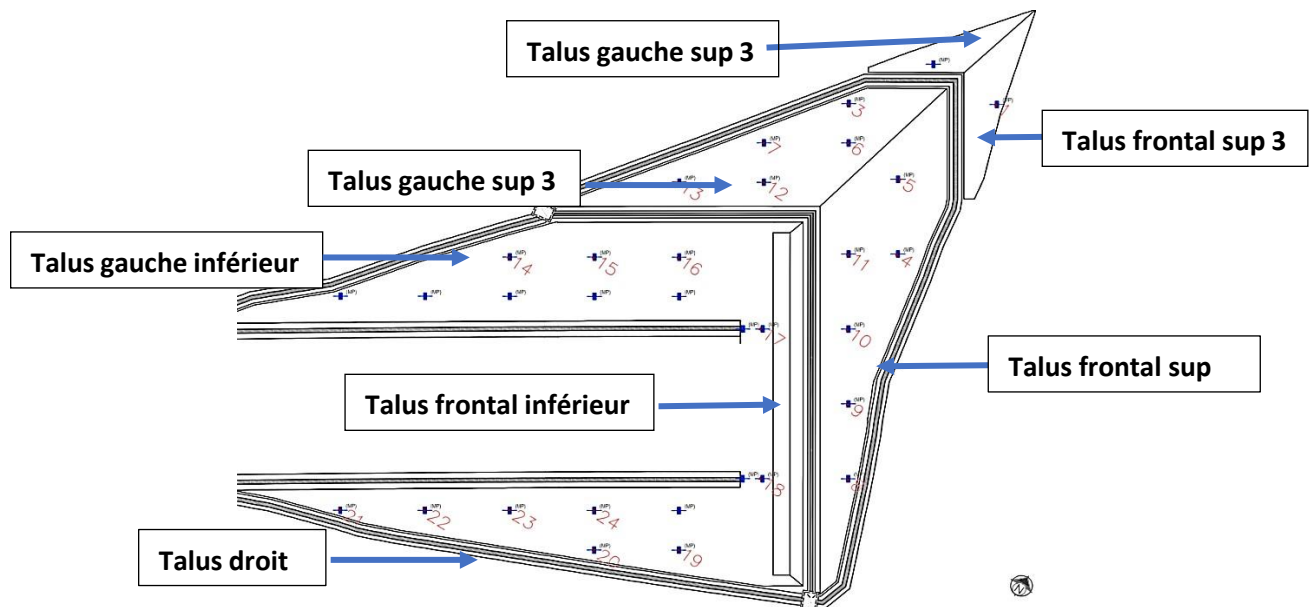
Vue en plan du positionnement des cibles sur les talus du portail ouest.
